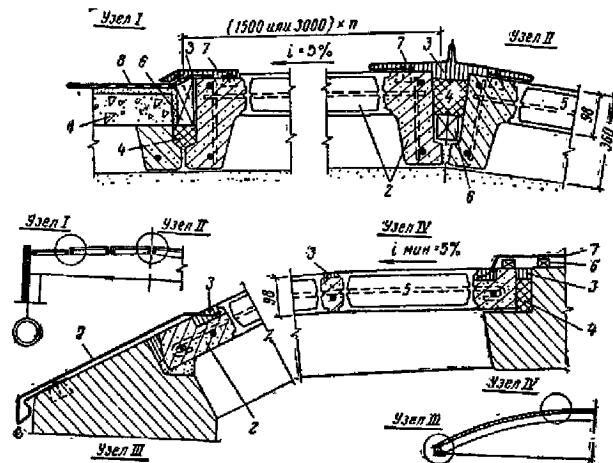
Устройство стекложелезобетонных покрытий по балкам (фермам) и в сводчатом покрытии
